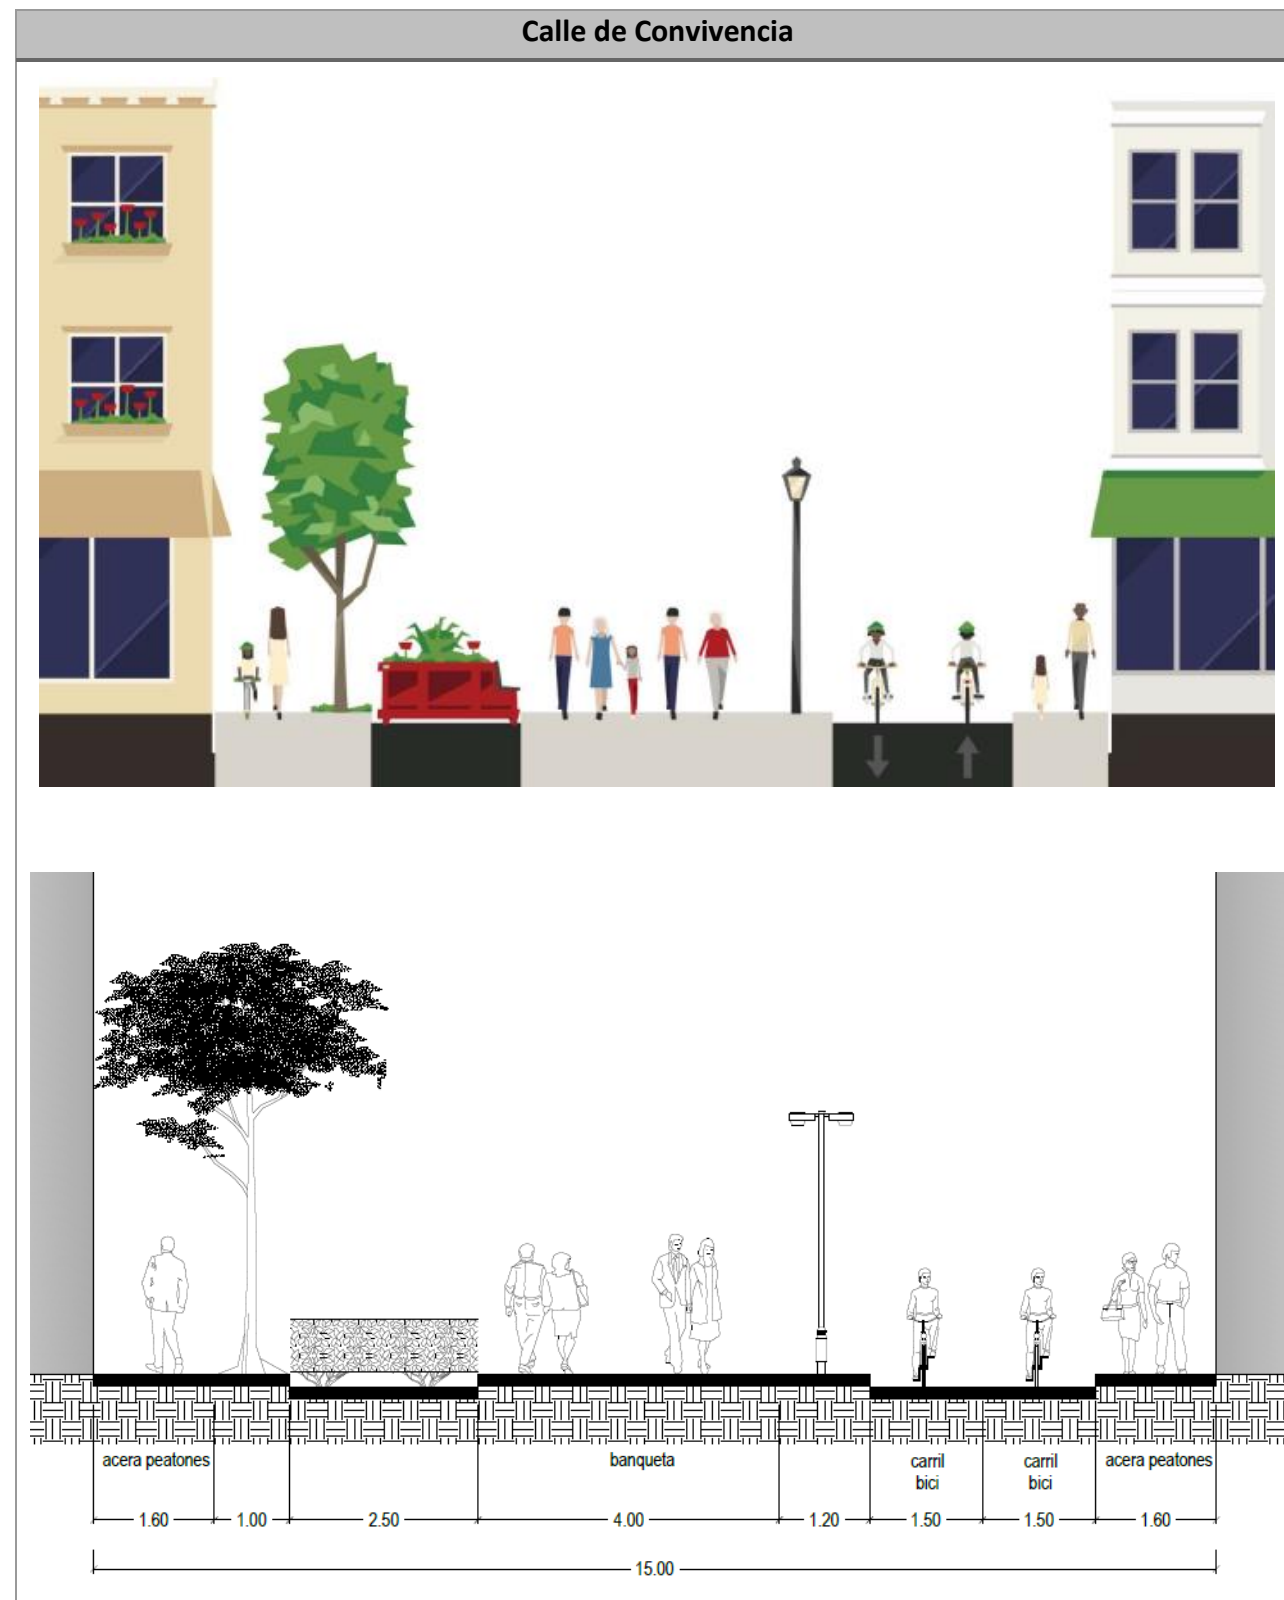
Sección transversal tipo para Calle de Convivencia. Fuente: Elaboración propia.
